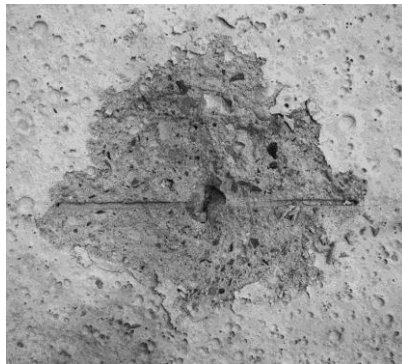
Betonausbruch in Pull-out-Versuch mit normalfestem Beton
